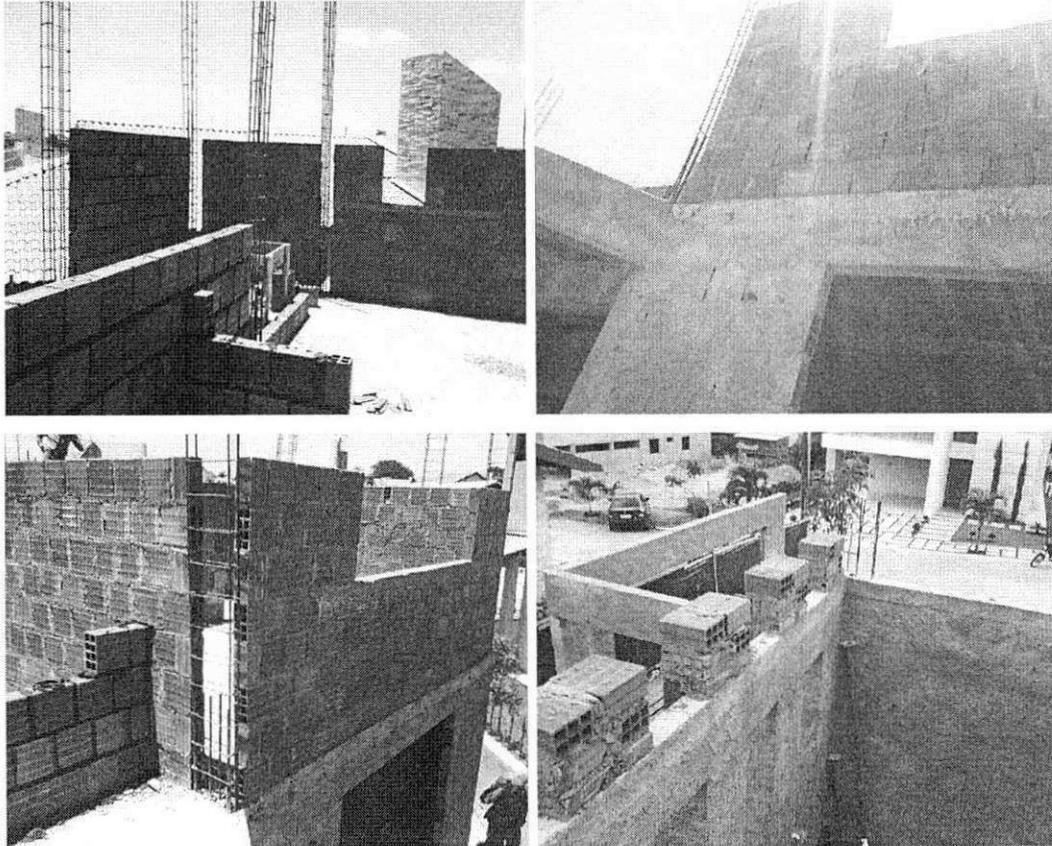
a 82 – Colocação das ferragens dos pilares e construção das paredes do 2º piso
